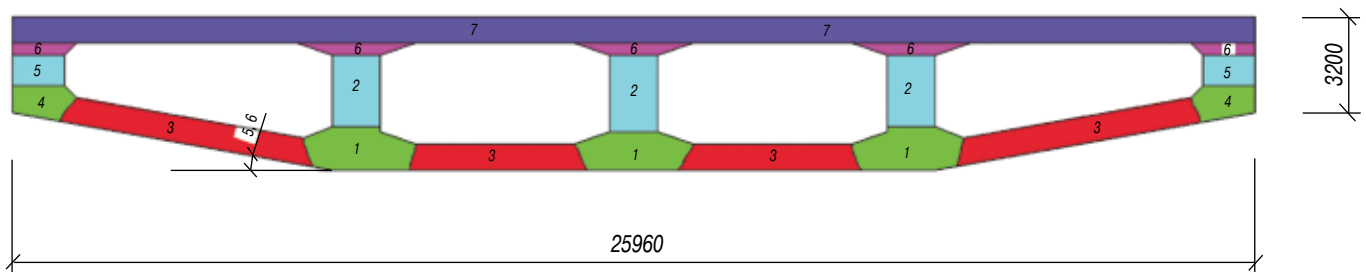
Схема укладки бетонной смеси в балку жесткости
